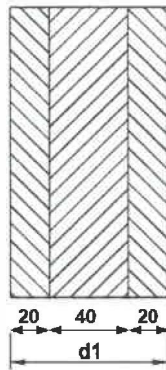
Beispiel eines dreilagigen Brettsperrholzelementes (Gesamtdicke 80 mm) mit der entsprechenden Mindestdicke der äußeren (tragenden) Brettlagen
